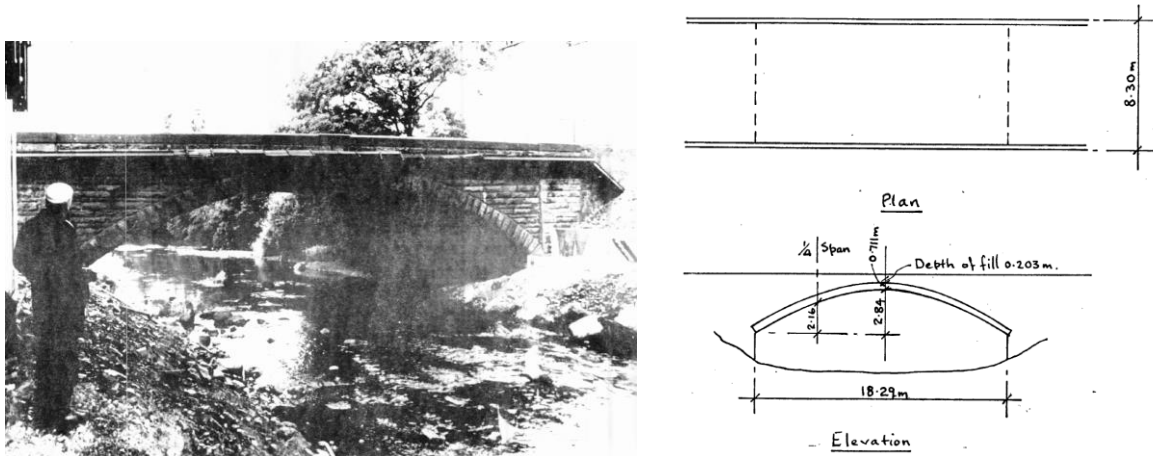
Bridgemill Bridge*: prospetto (a sinistra) e schema planimetrico / prospettico (a destra). [51]
